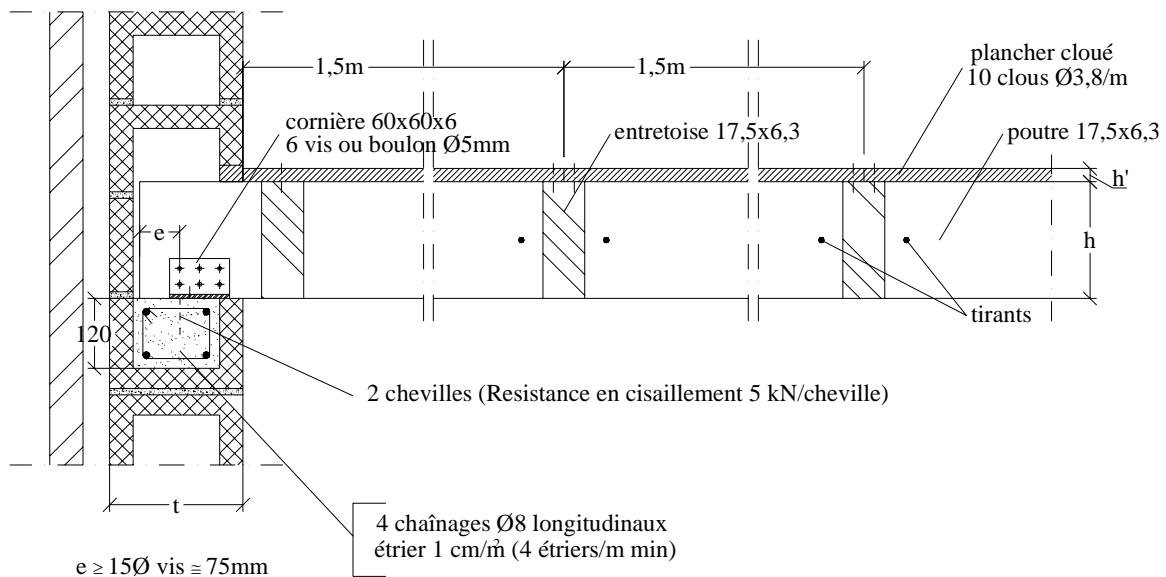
Liaison par ancrage entre poutre de plancher en bois et mur.
